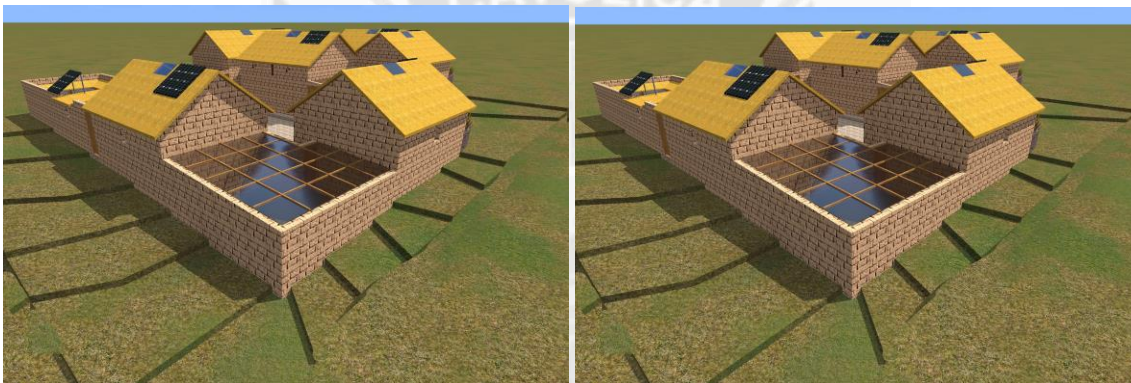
Vistas aéreas Posteriores – Fuente: Propia
